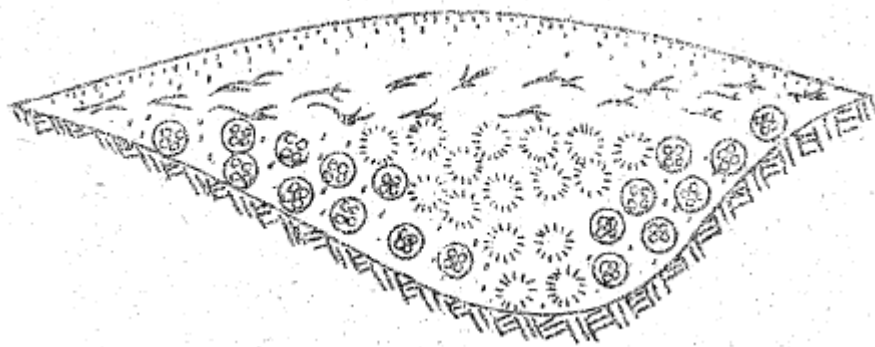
Hráz vybudovaná ze dřeva a zeminy
